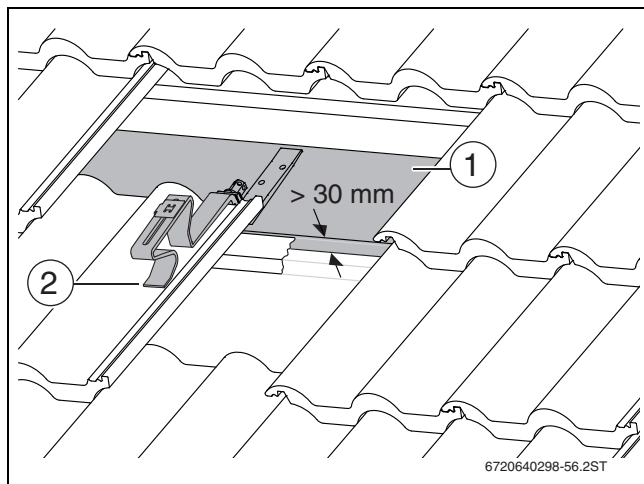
Montage du crochet de toiture sur la planche/le madrier
